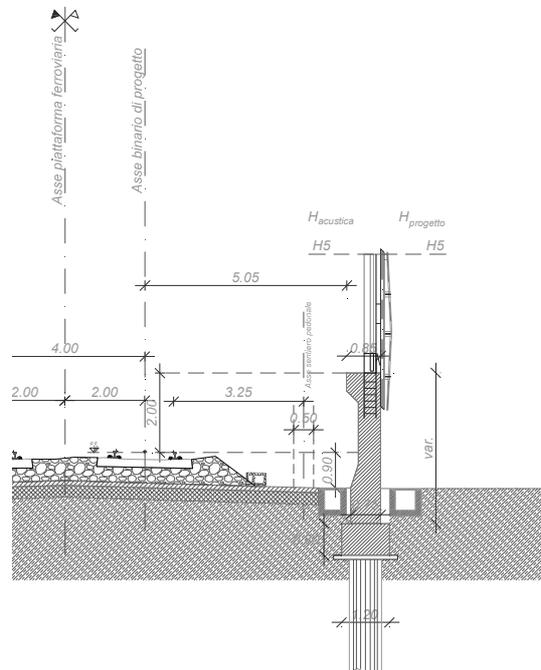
Sezione tipo tipologica BA “HS” rettificato senza manufatto prefabbricato fondato su OdS
